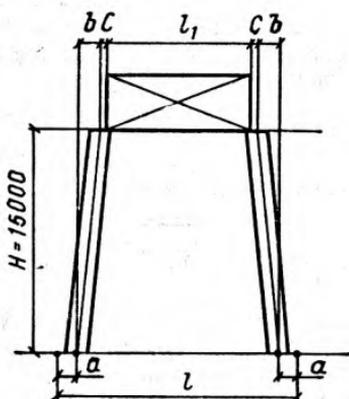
Схема опирания блока покрытия на колонны (вдоль ряда колонн)
